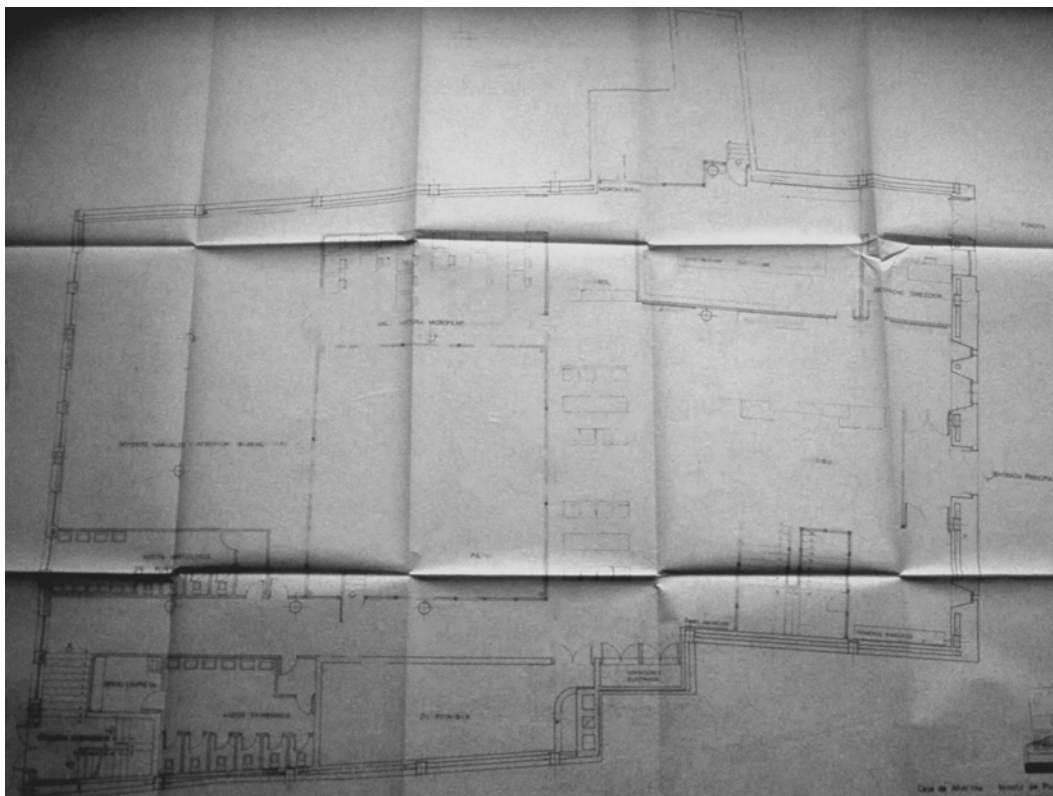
Biblioteca de Santa María de los Ángeles: planta baja, por J. E. Díez y R. Pérez, septiembre de 1982.
